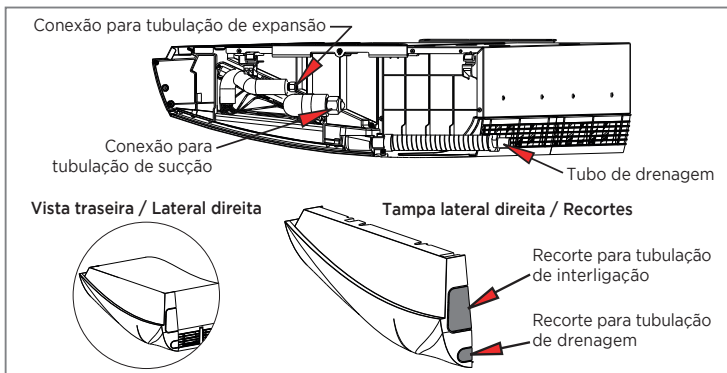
TUBULAÇÕES DE INTERCONEXÃO E DRENAGEM
